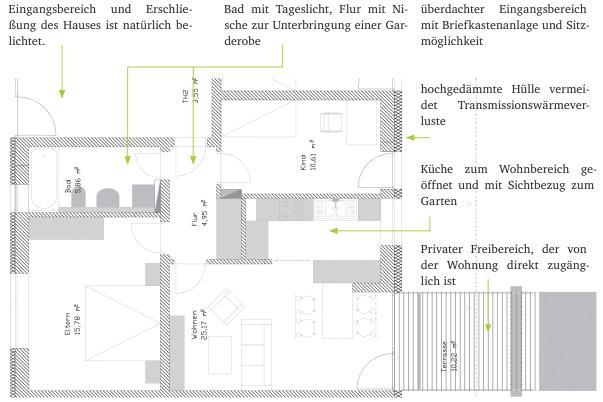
Grundriss o. M., Grafik: Architekturbüro Reiszky
